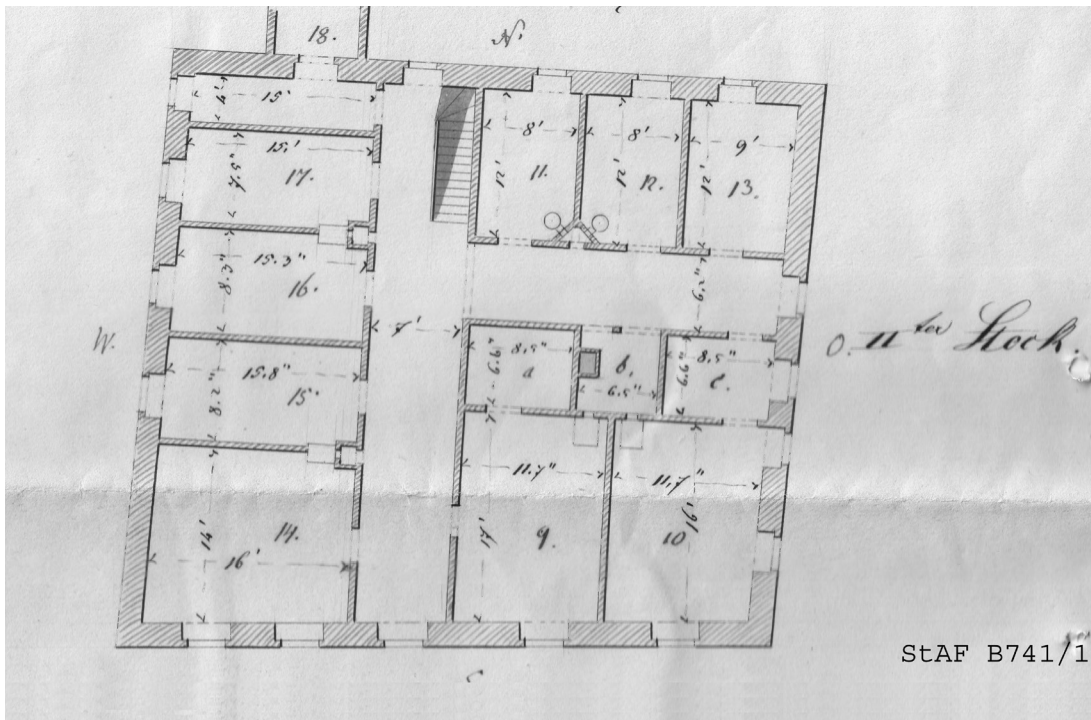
Spitalstraße 33, Grundriss 1. Obergeschoss im Jahr 1846.
